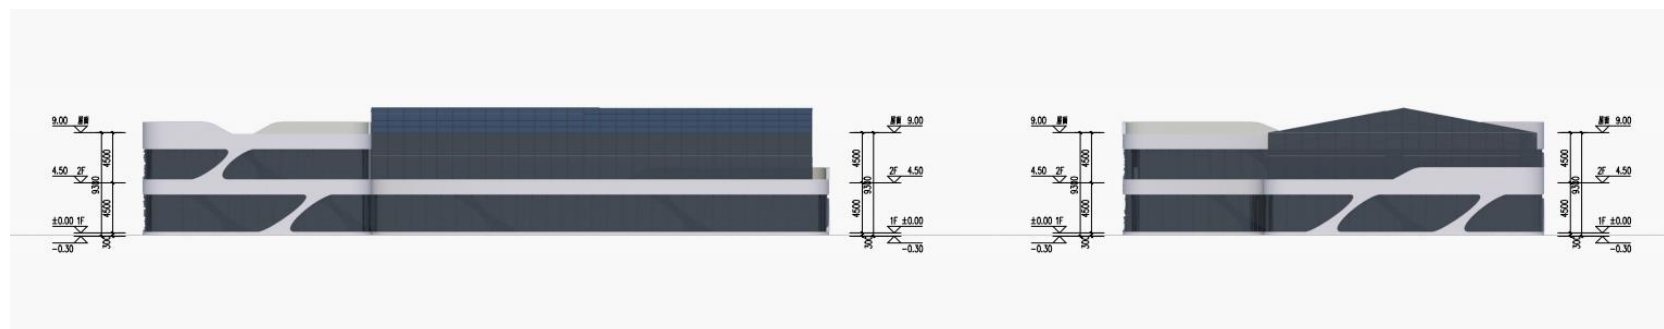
汕头农作物品种繁育研发基地西北立面图（左）及现代设施农业展示基地东北立面图（右）
